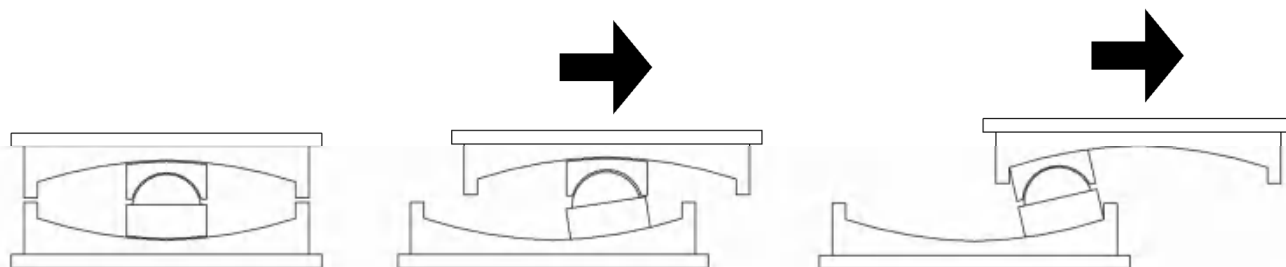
Принцип действия двухмаятниковой скользящей опоры
